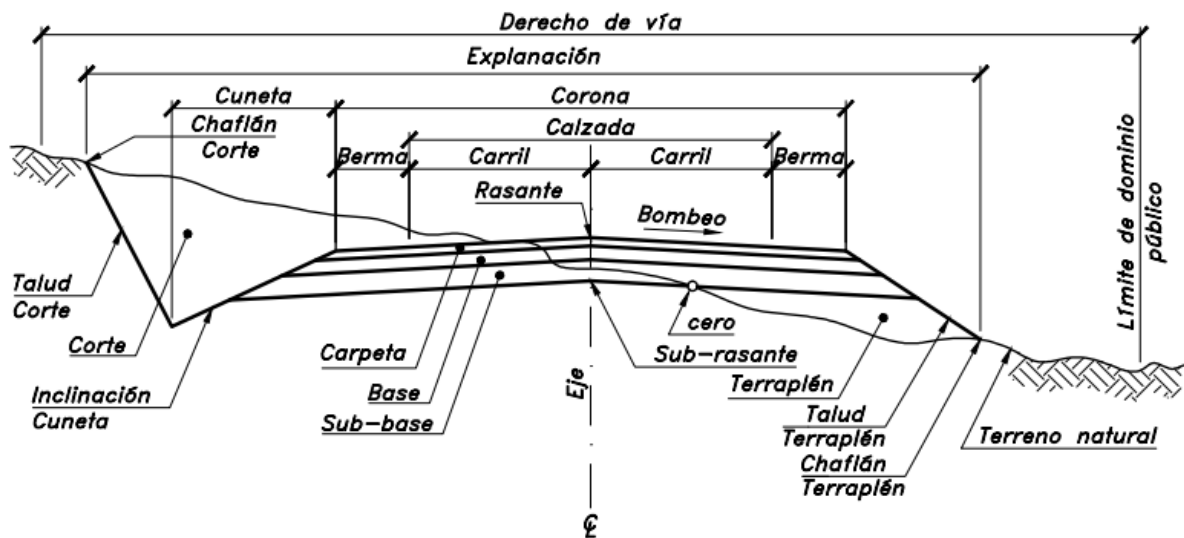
Sección transversal típica mixta, pavimentada en recta
